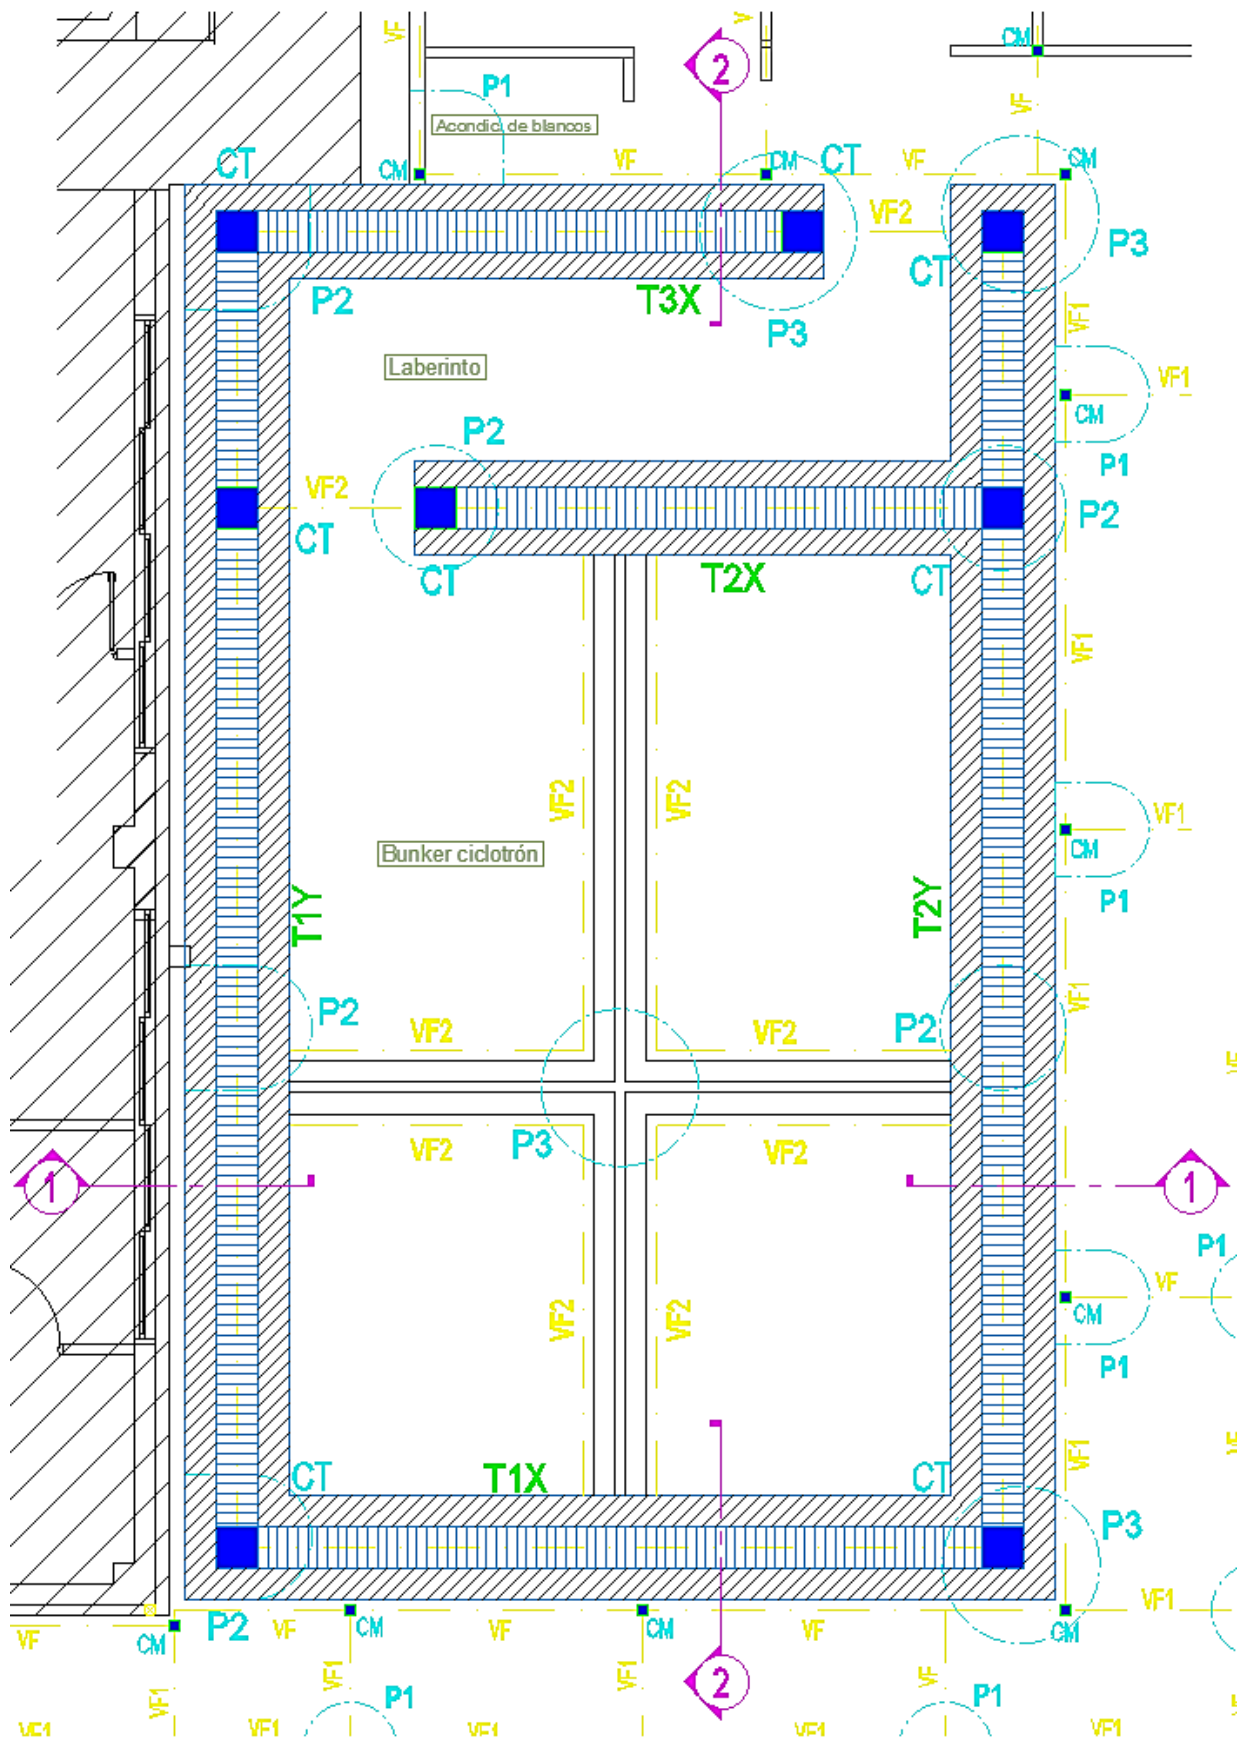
Planta estructural de fundaciones del bunker y laberinto
